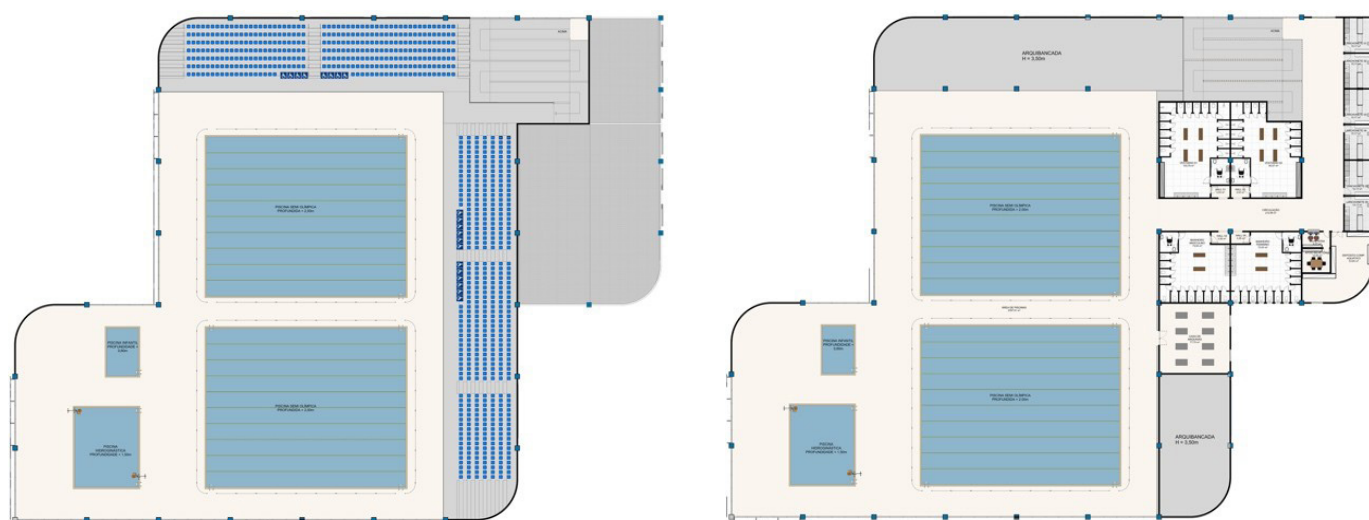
e 8. Layout Complexo Aquático Fonte: Plantas de layout elaborada pelos autores, 2023
